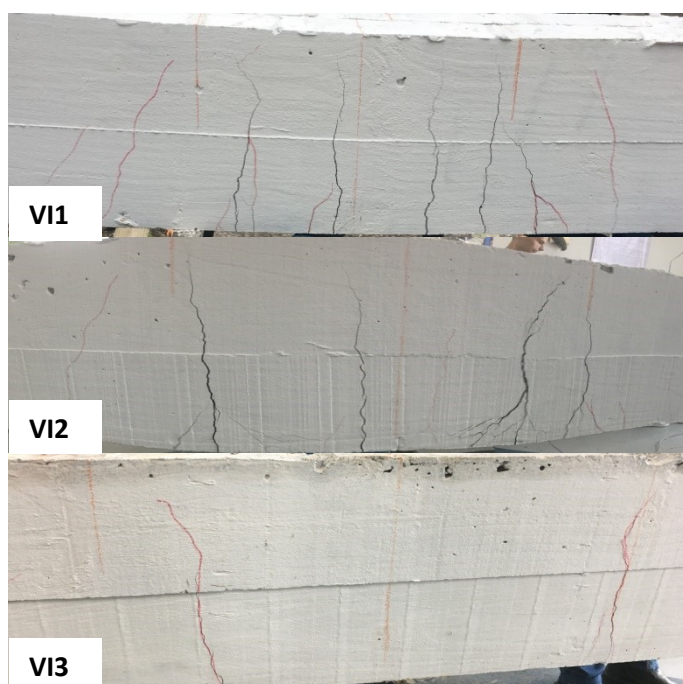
Mapeamento das fissuras nas vigas do grupo VI.
